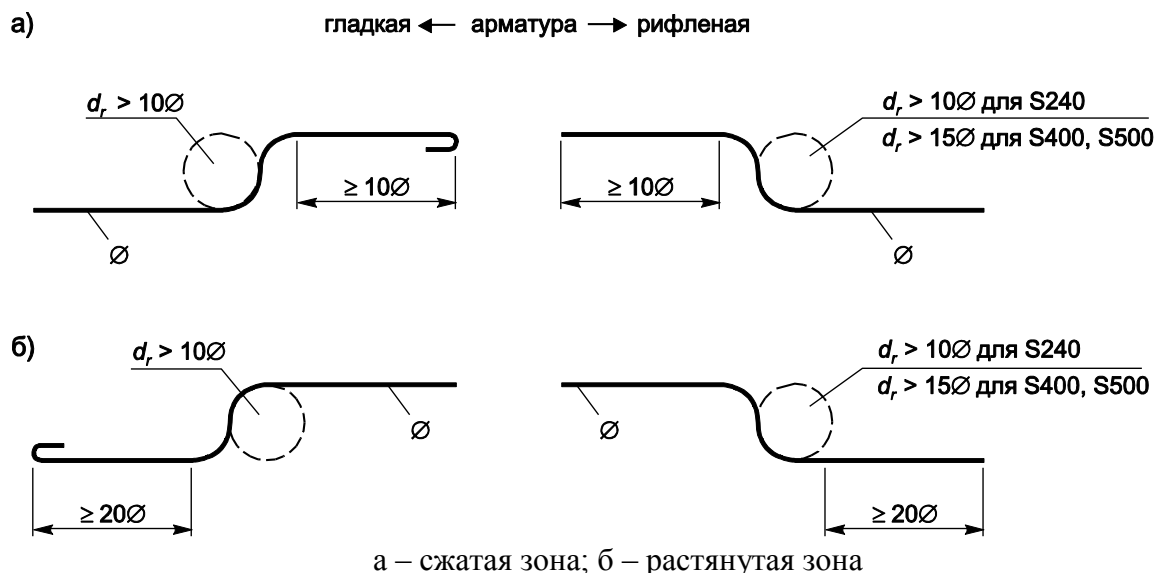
Условия анкерки арматуры при отгибе и обрыве
